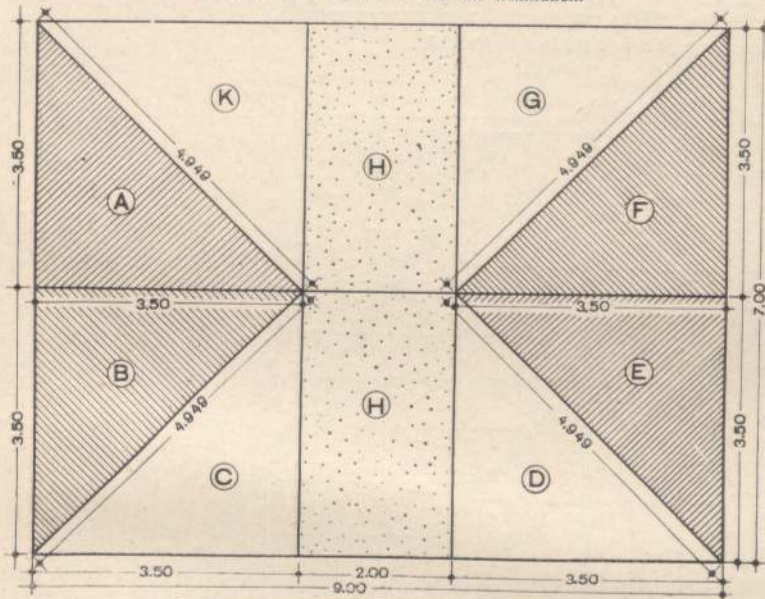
Die Dachausmittlung zu dem Walmdach.
